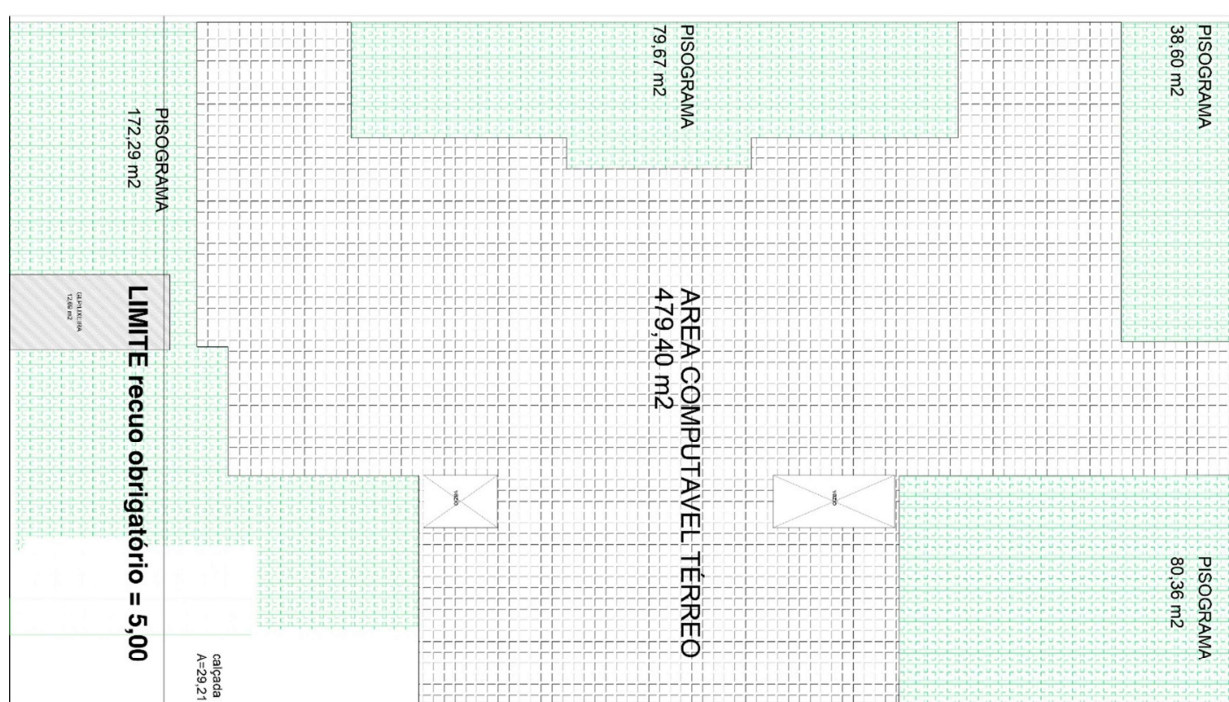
ILUSTRAÇÃO DA AREA PERMEAVEL NA EDIFICAÇÃO
